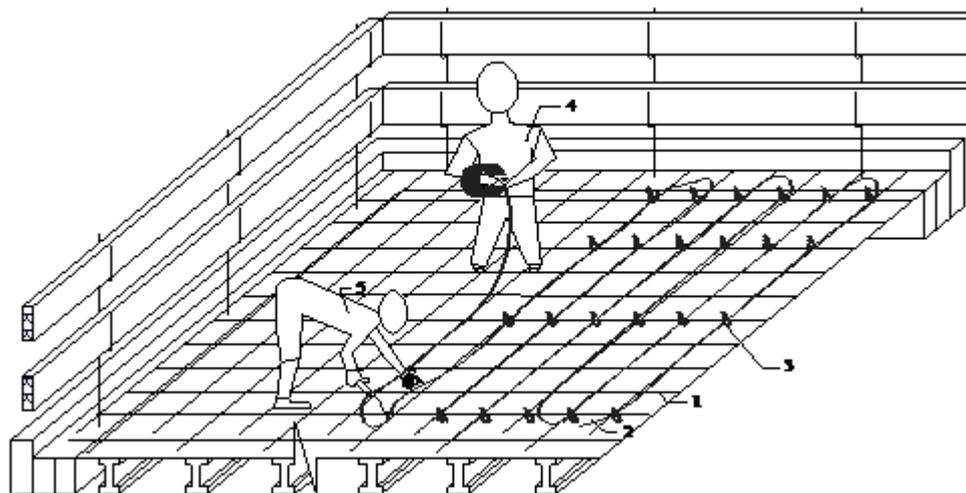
Схема укладки греющего провода: 1 стержень арматурной сетки;
